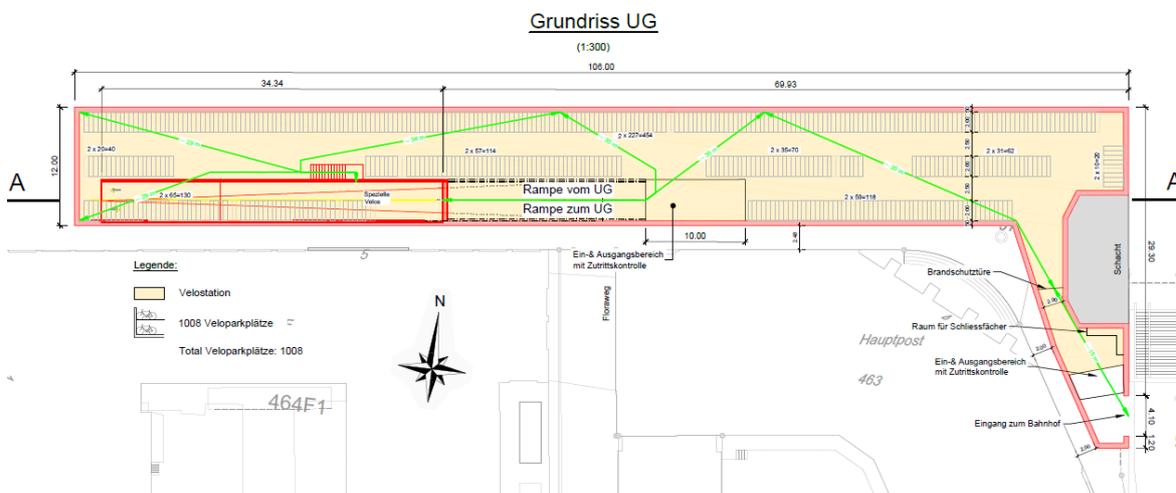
Grundriss UG der geplanten Velostation, mit ewl-Schacht (1'008 Veloabstellplätze)
